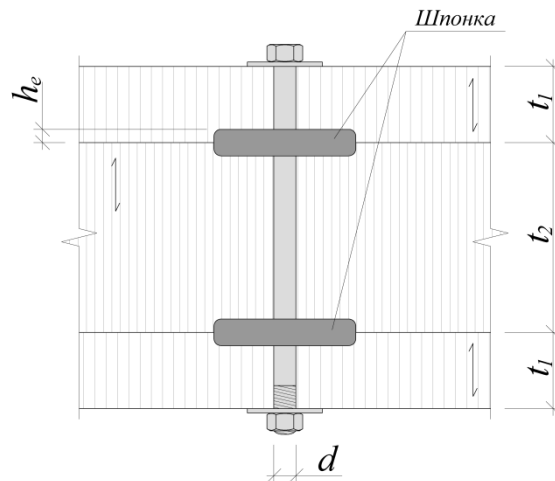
Схемы узла со шпонками с обозначением размеров
